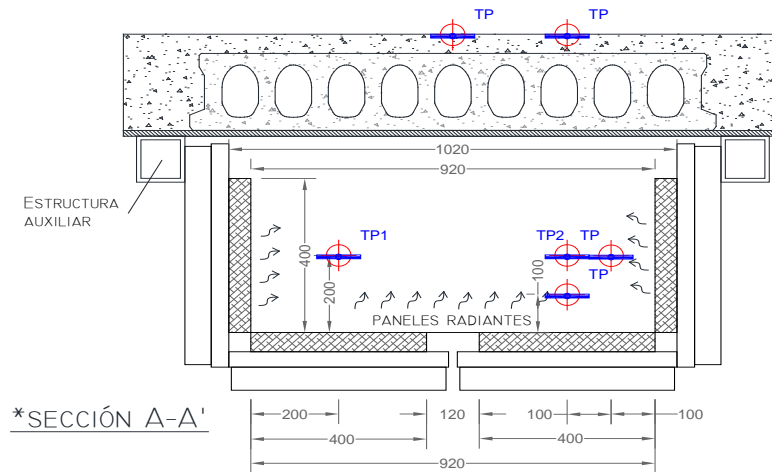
Plano de sección transversal del horno construido para los ensayos.
